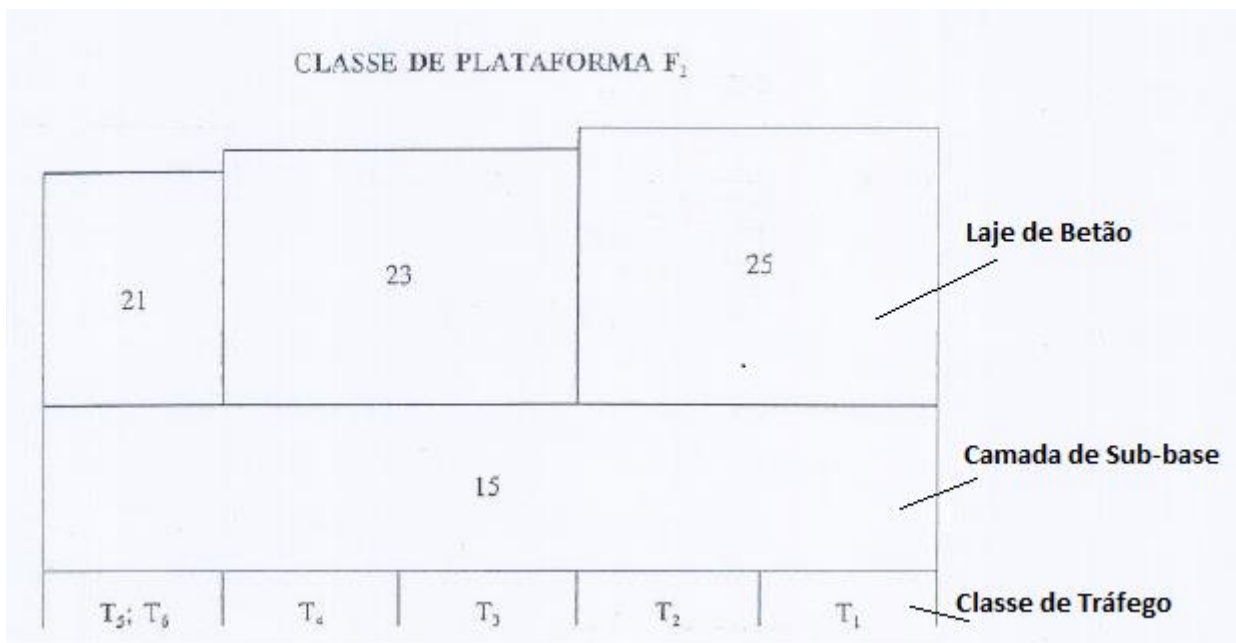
Estruturas de pavimentos para a classe F2 segundo MACOPAV
